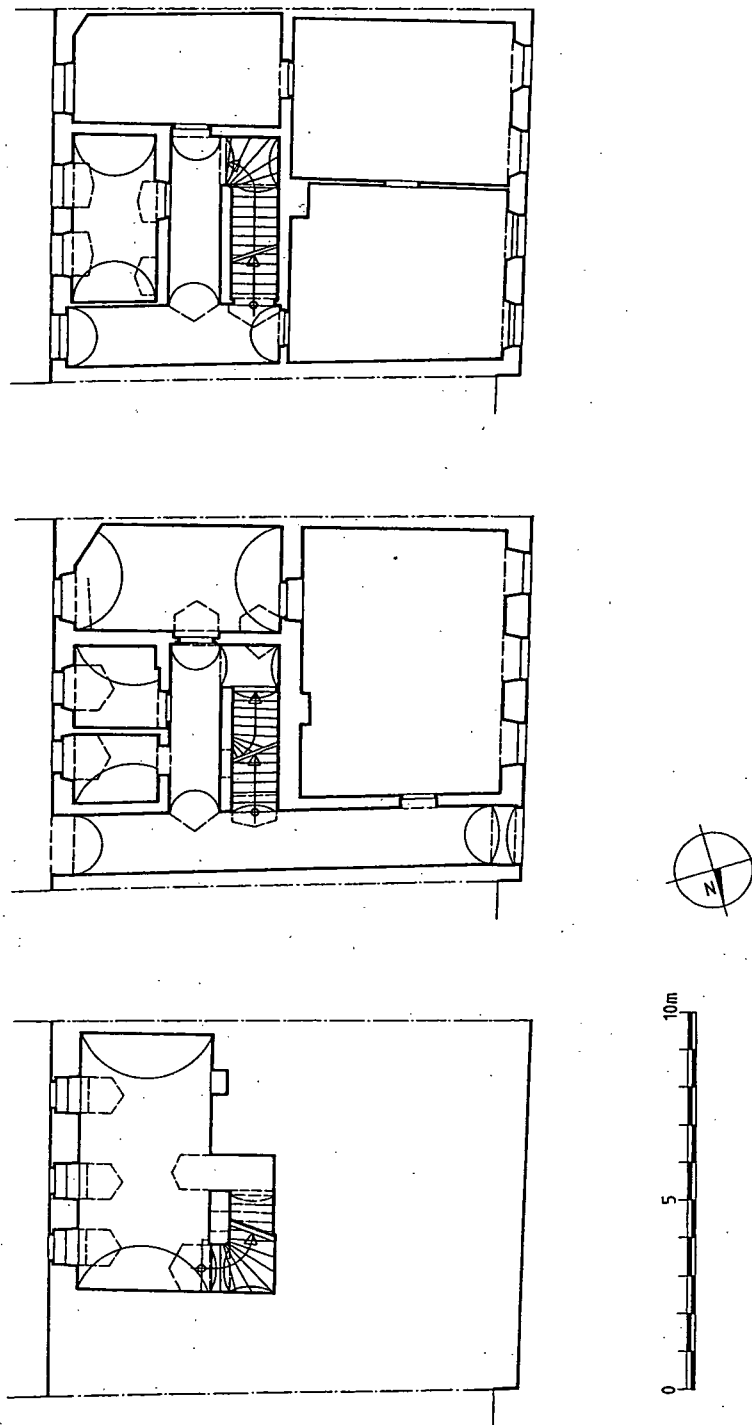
Starhembergstraße 8 – Grundrisse Keller, Erdgeschoss, Obergeschoss (1:200).
